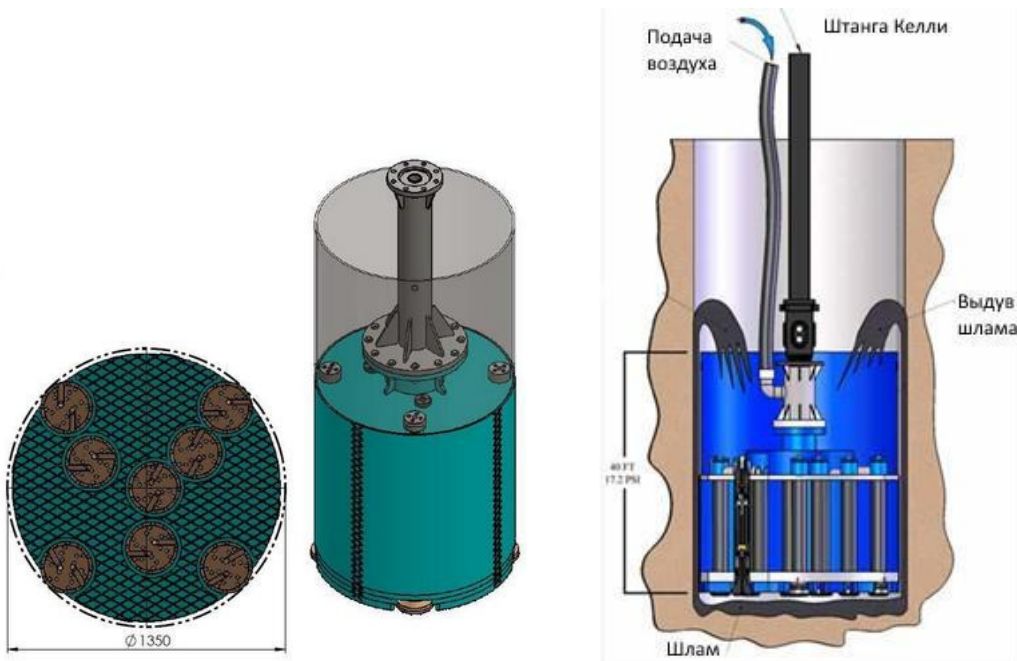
Кластерные пневмоударники с корзиной для сбора шлама
